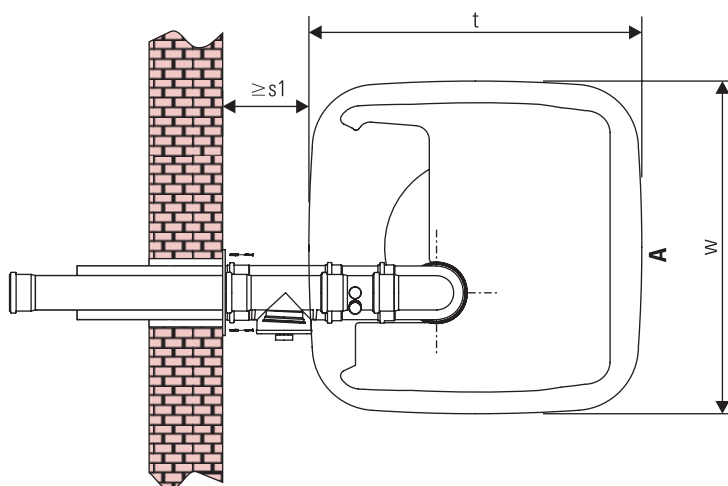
Vista dall'alto ROTEX GSU raccordo scarico fumi di lato con set K (vedere sezione 3.5.3)
